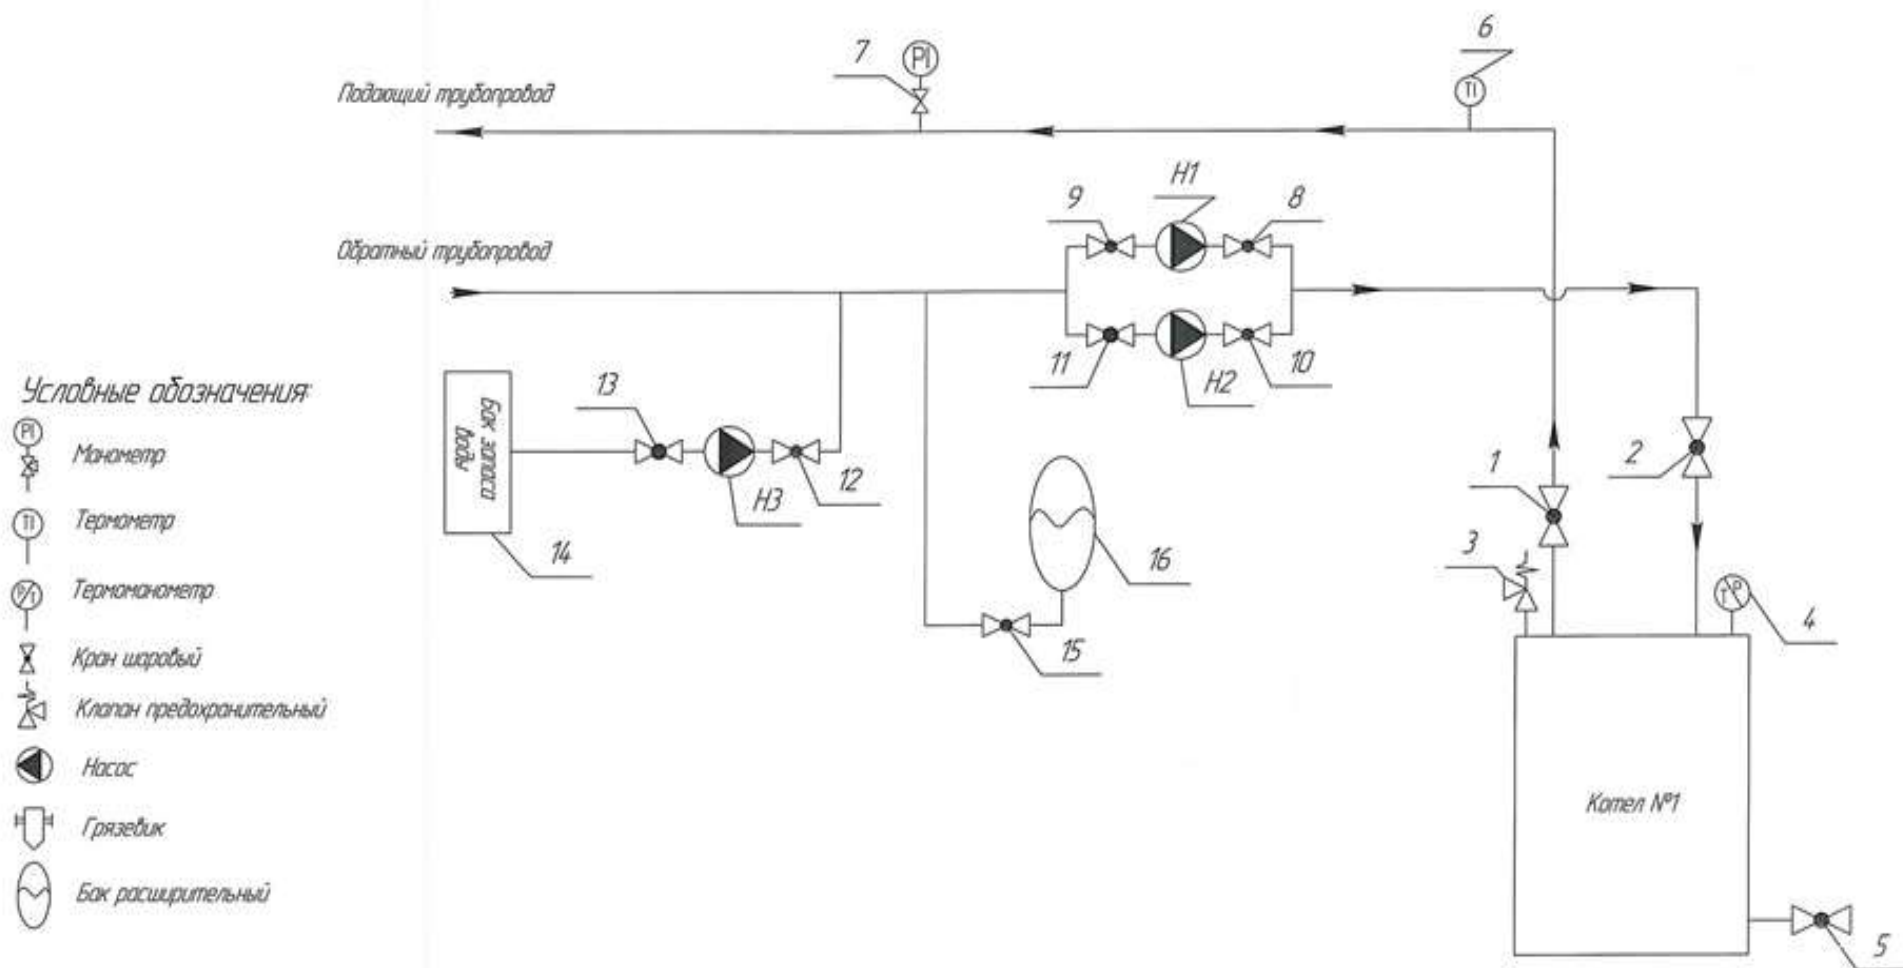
Тепломеханическая схема котельной №6-35 с. Коханы
